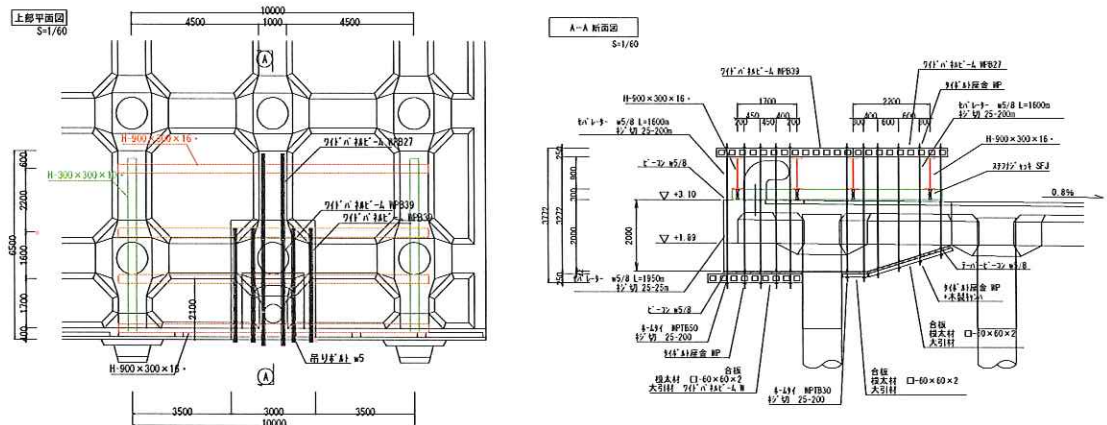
吊支保の構造図(左：平面図、右：側面図)
